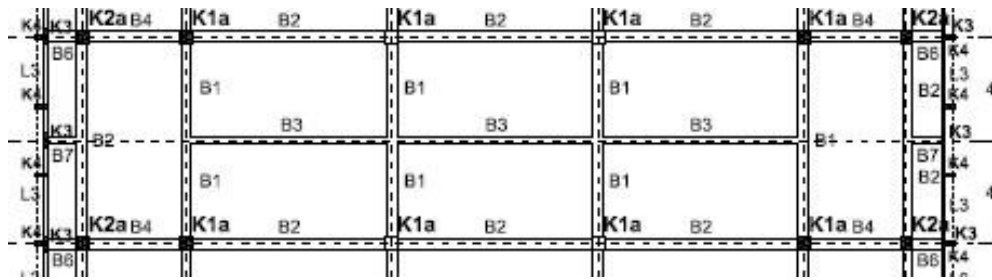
Denah plat dan balok lantai 2 Gedung Mpp Klaten
